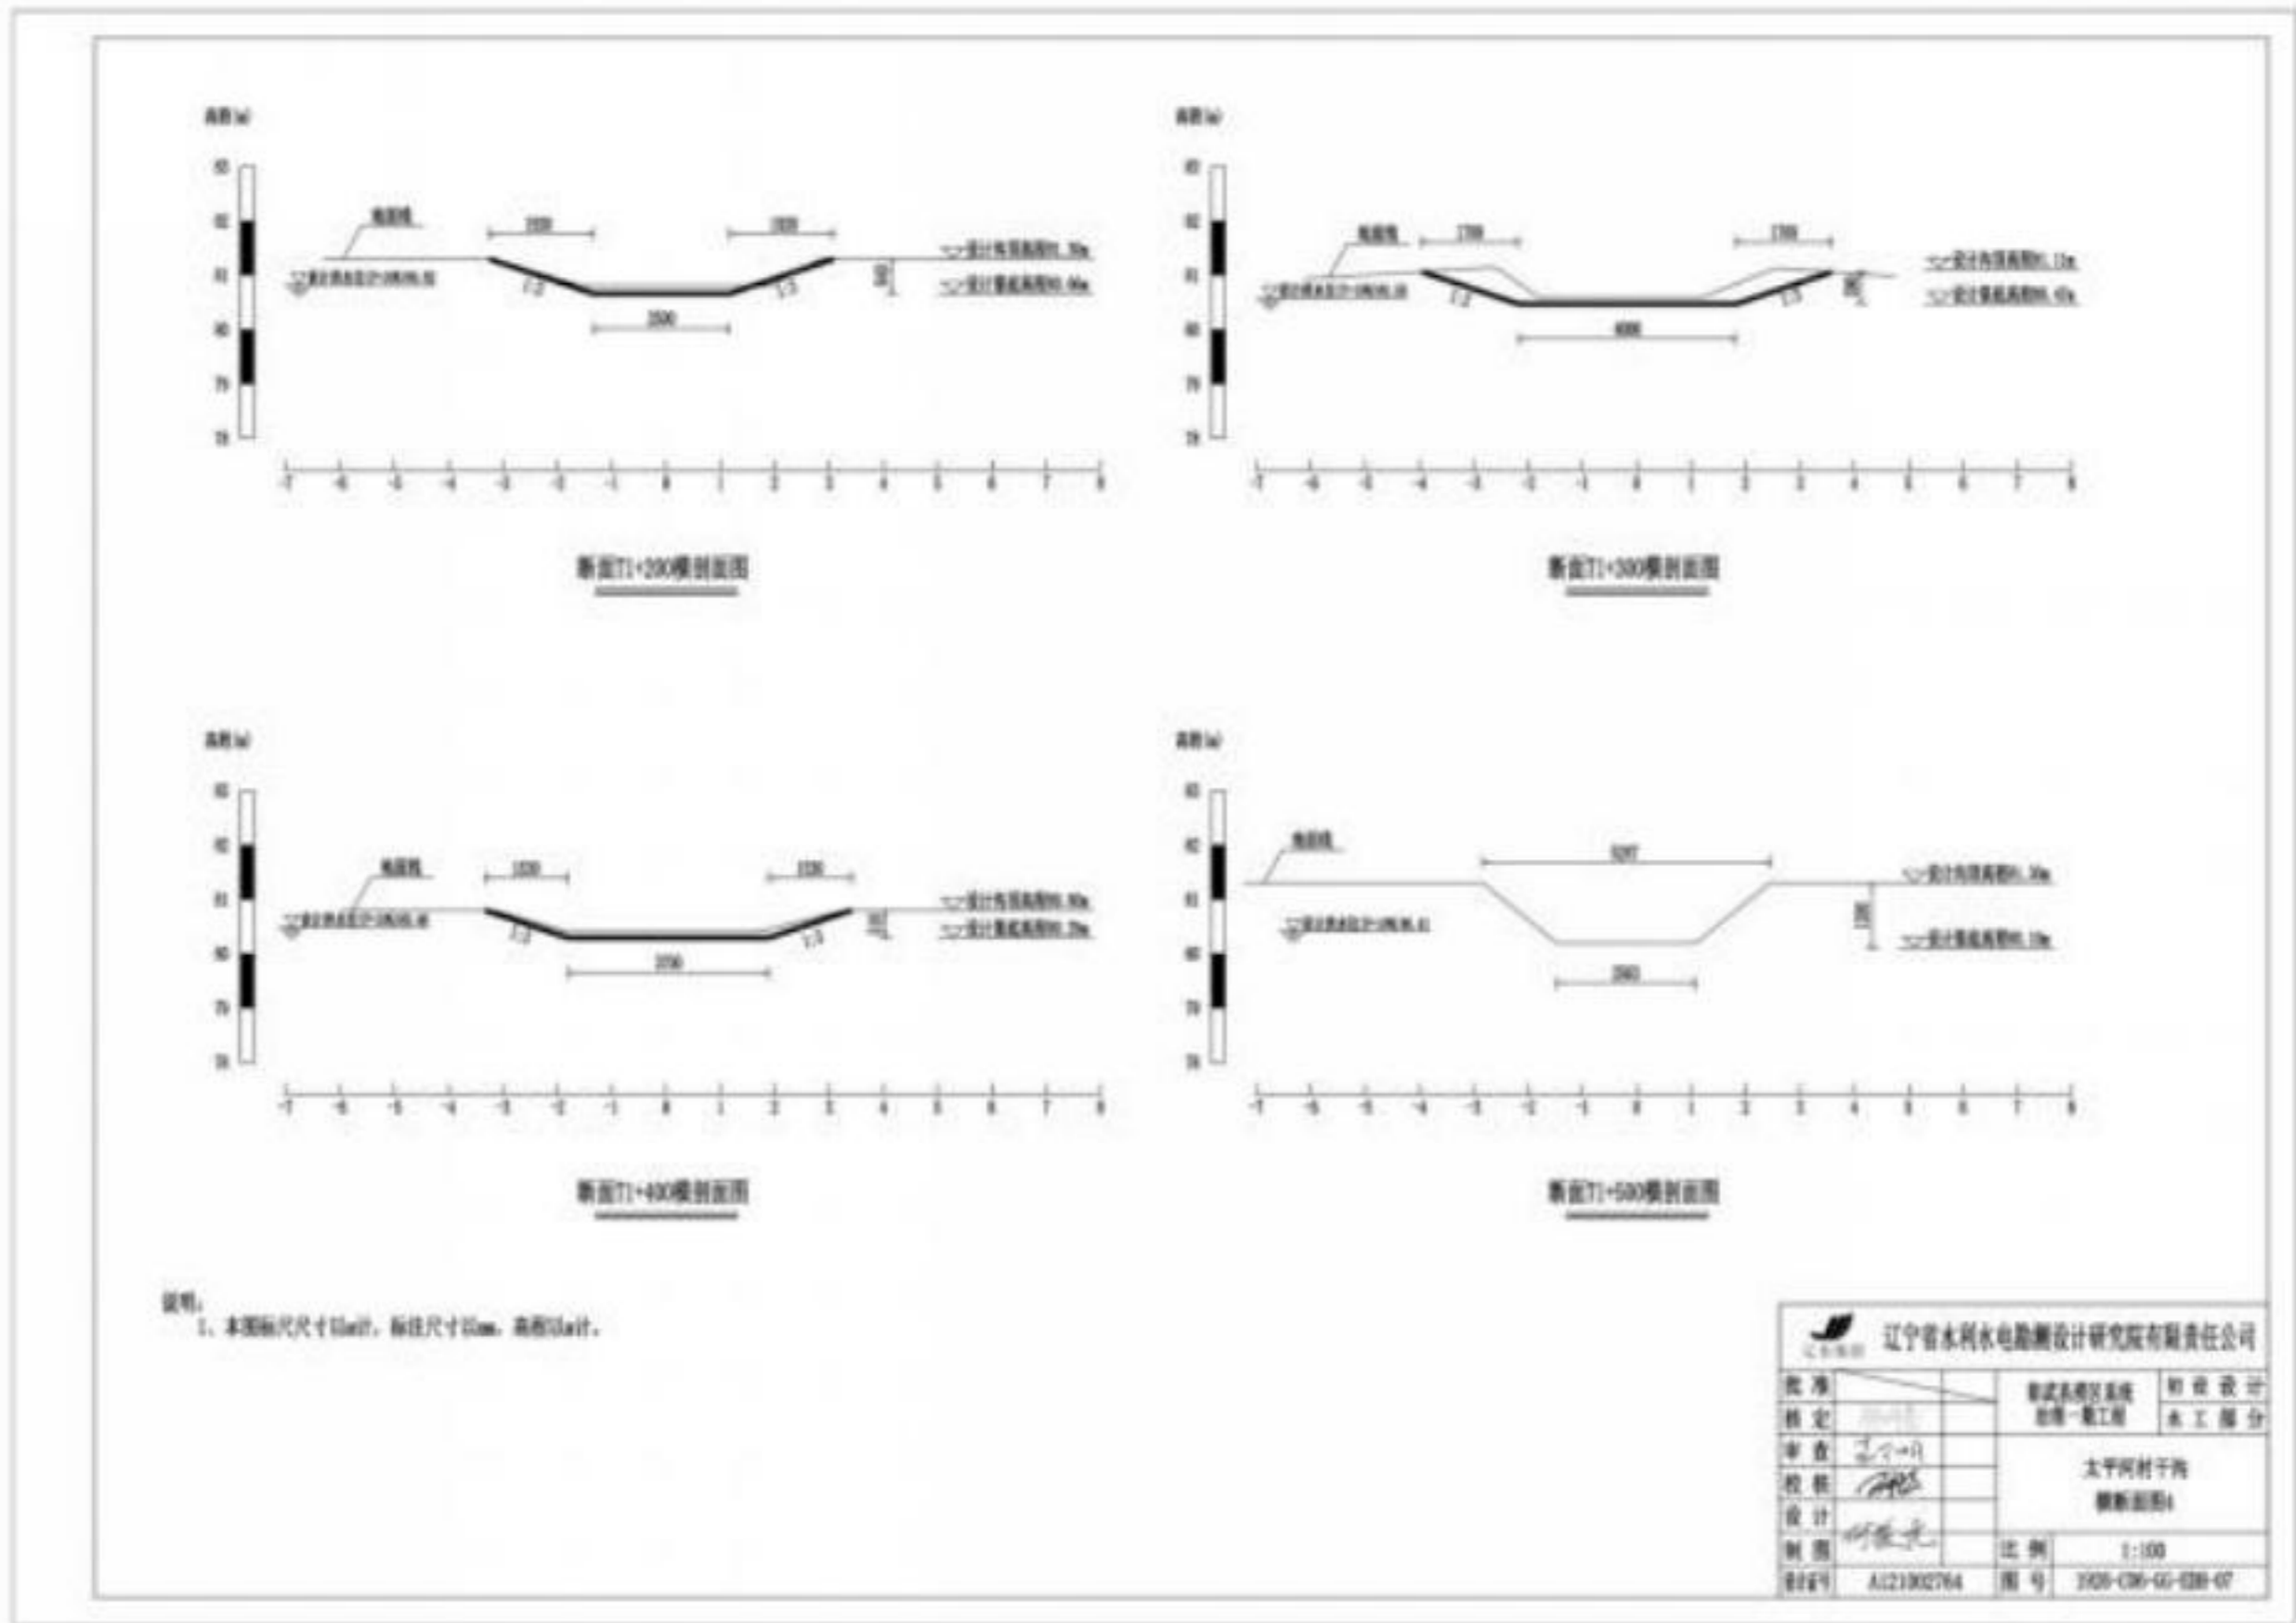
（4） 二道河子乡太平河村干沟剖面图
